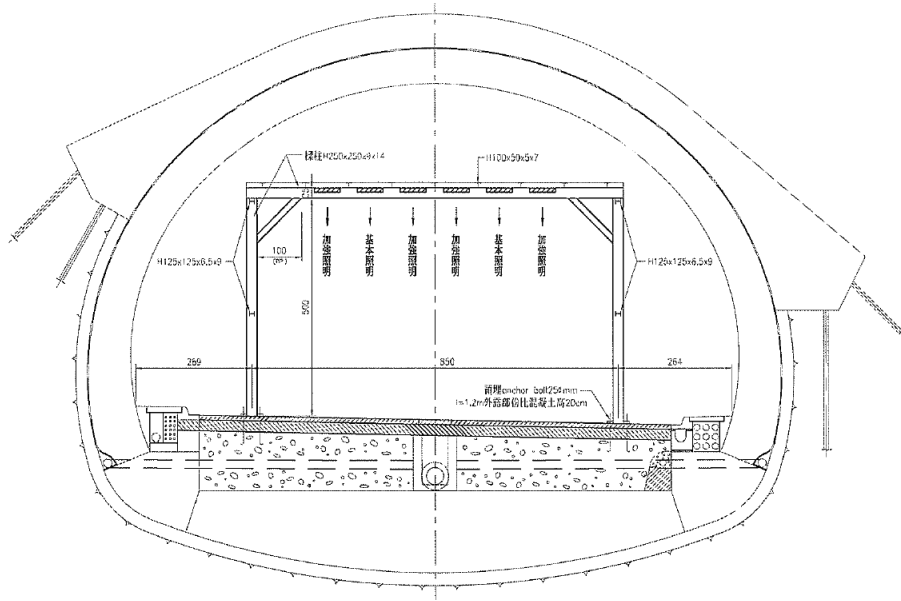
施工中臨時照明配置斷面示意圖
